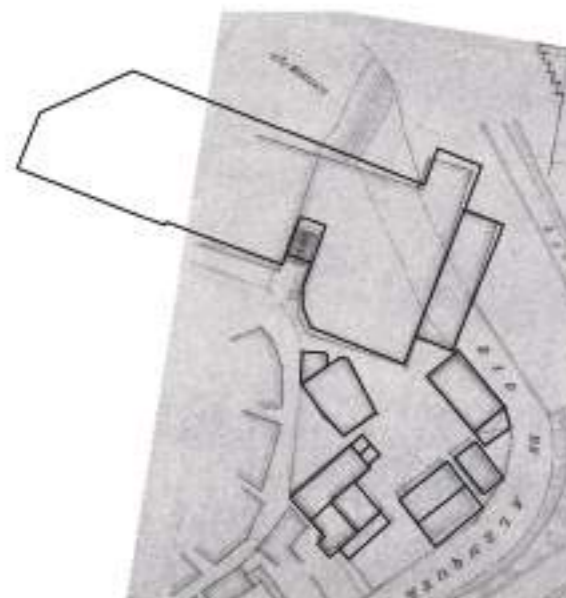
Esquema sobreposição Planta Fábrica 1958.
